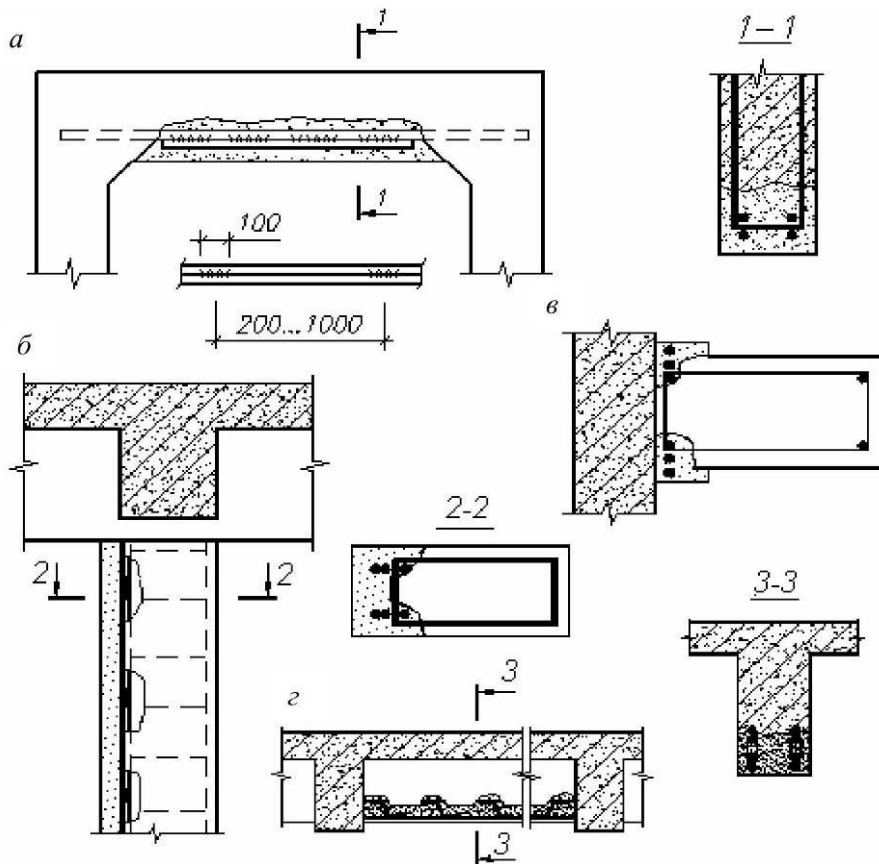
Посилення розтягнутої зони залізобетонних конструкцій шляхом приварювання додаткової арматури [5]
